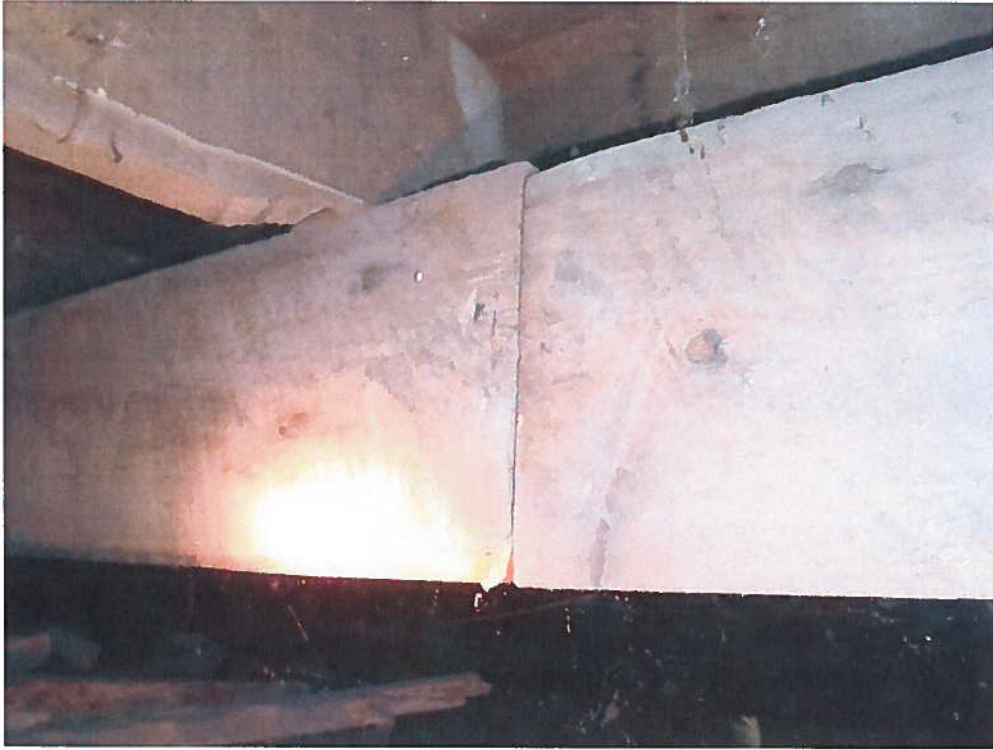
Jonction d'un pli de poutre assemblé faiblement et s'étant un peu affaissée
